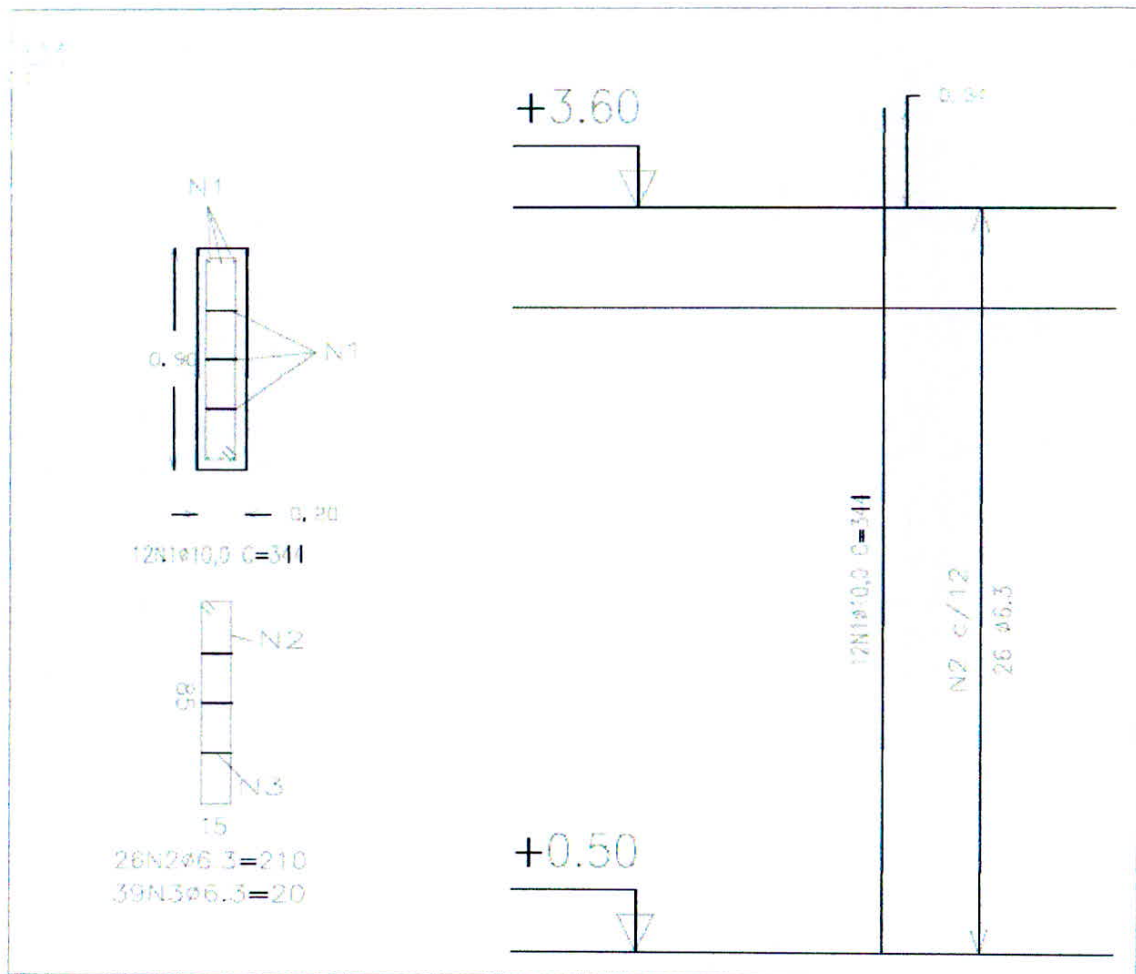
detalhamento P1, NBR 6118:2014.
